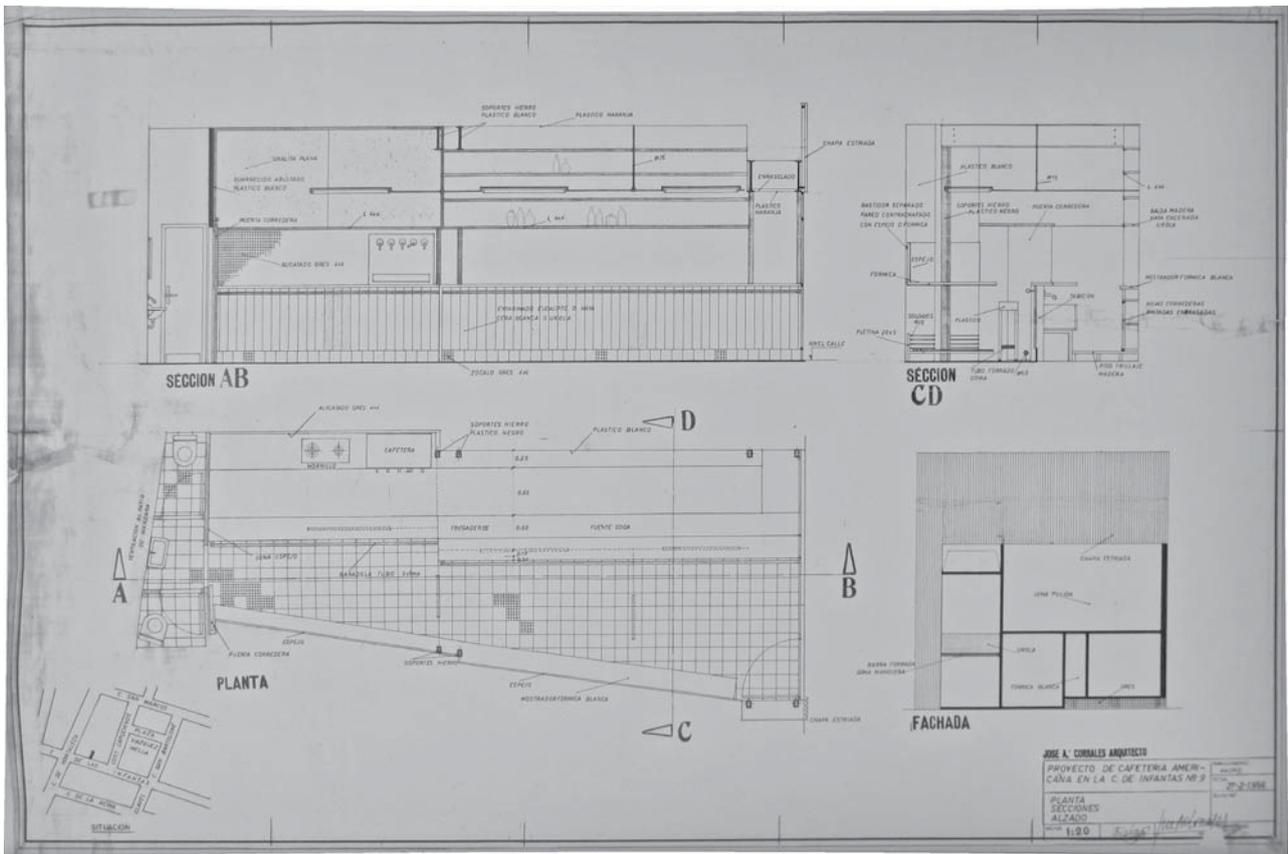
J.A. Corrales. Cafetería americana. Plano de proyecto. Plantas, secciones y alzado. Madrid. 1956. Archivo Corrales
